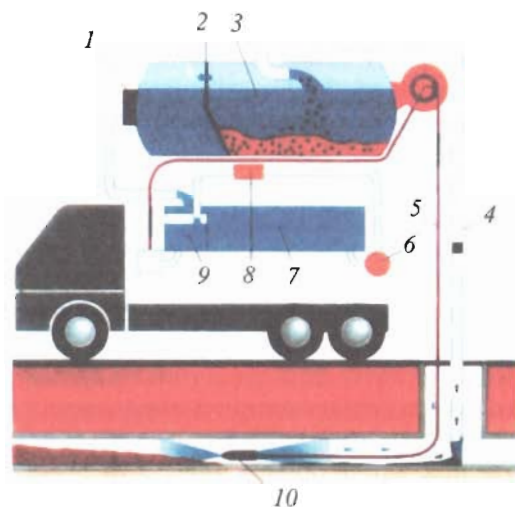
Гидропрочистка трубопроводов от отложений и ржавчины: 1 — фильтр; 2 — разделительная перегородка; 3 — резервуар; 4 — всасывающая труба; 5 — гидрошланг; 6 — центробежный насос; 7 — цистерна; 8 — гидrocиклон; 9 — коллектор; 10 — вращательная головка
